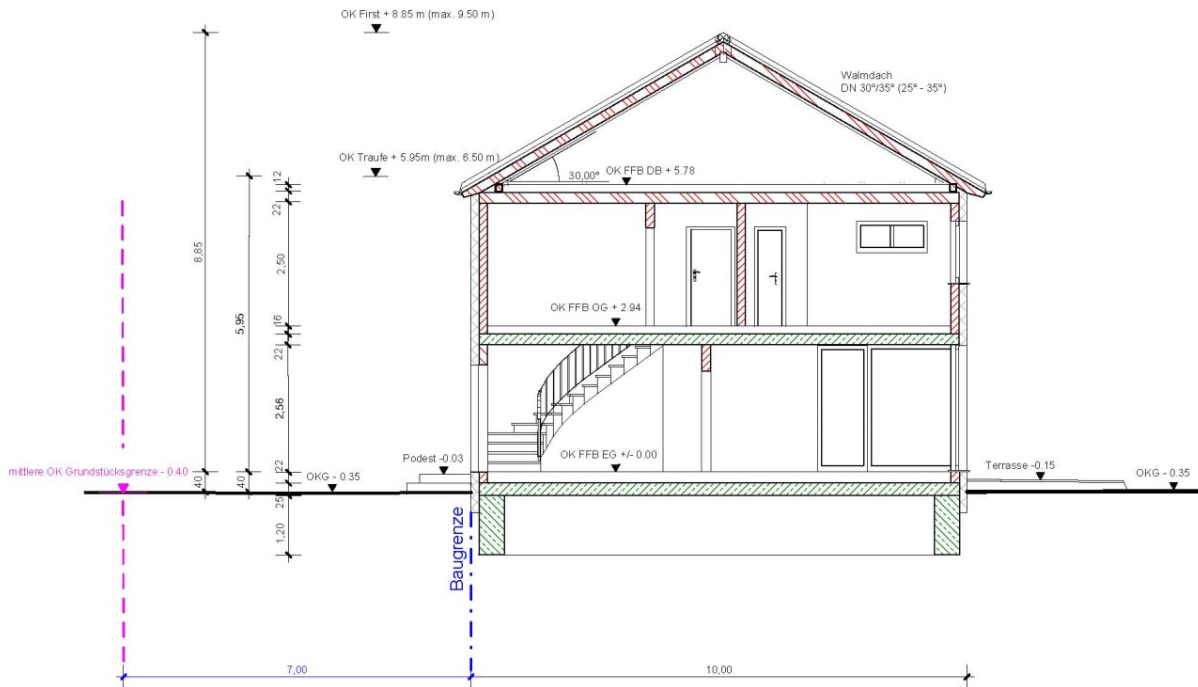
Systemschnitt zweigeschossiger Baukörper
